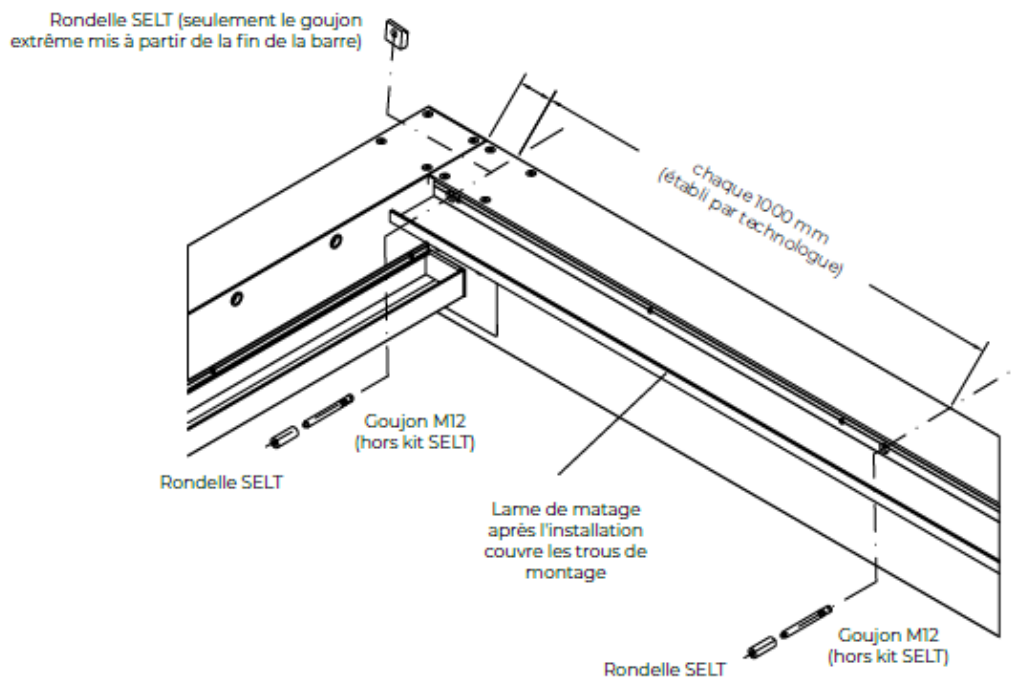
Méthode d'ancrage des murs sur les poutres transversales - solution alternative (l'ancrage sur les poutres longitudinales est préférable)
